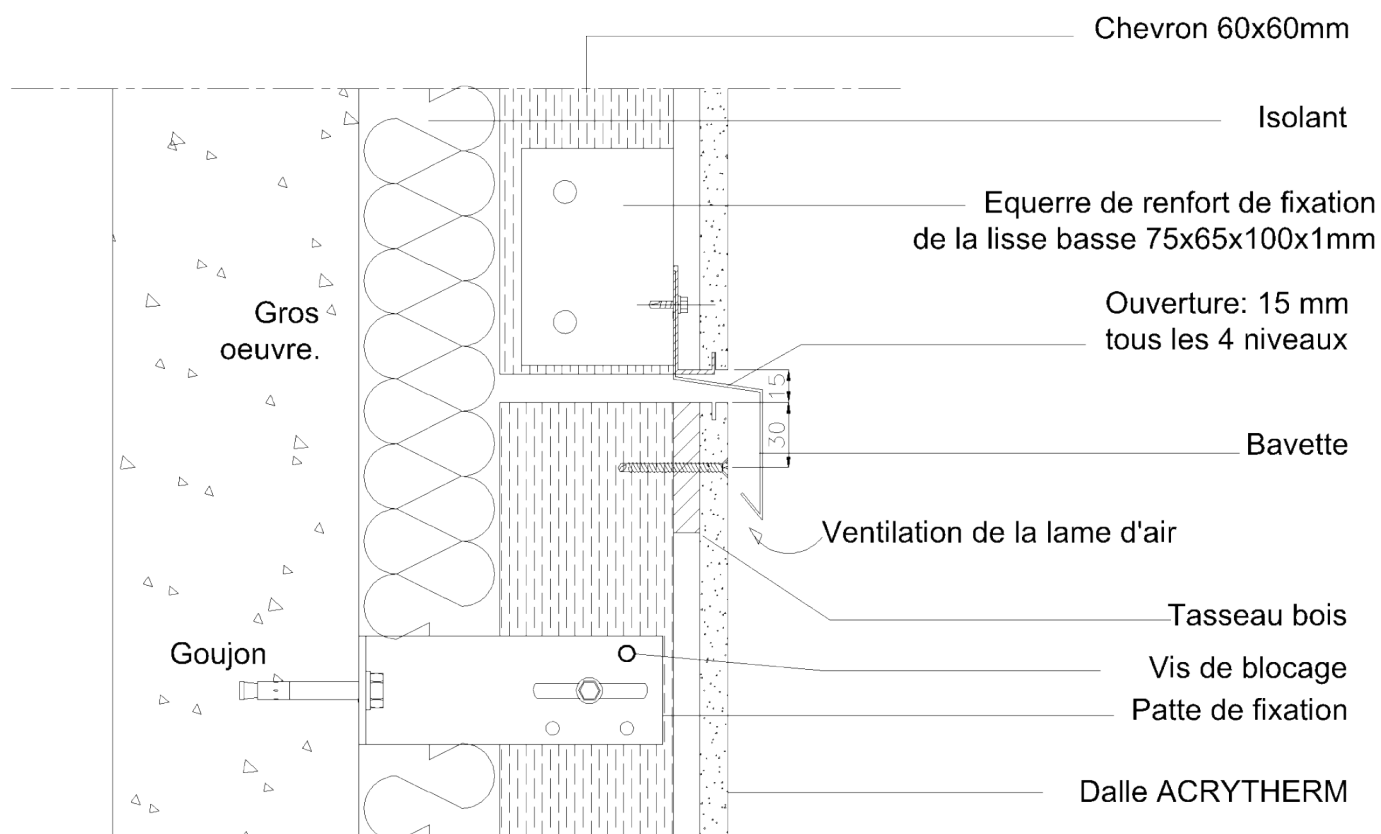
Coupe verticale – Fractionnement de l'ossature verticale
